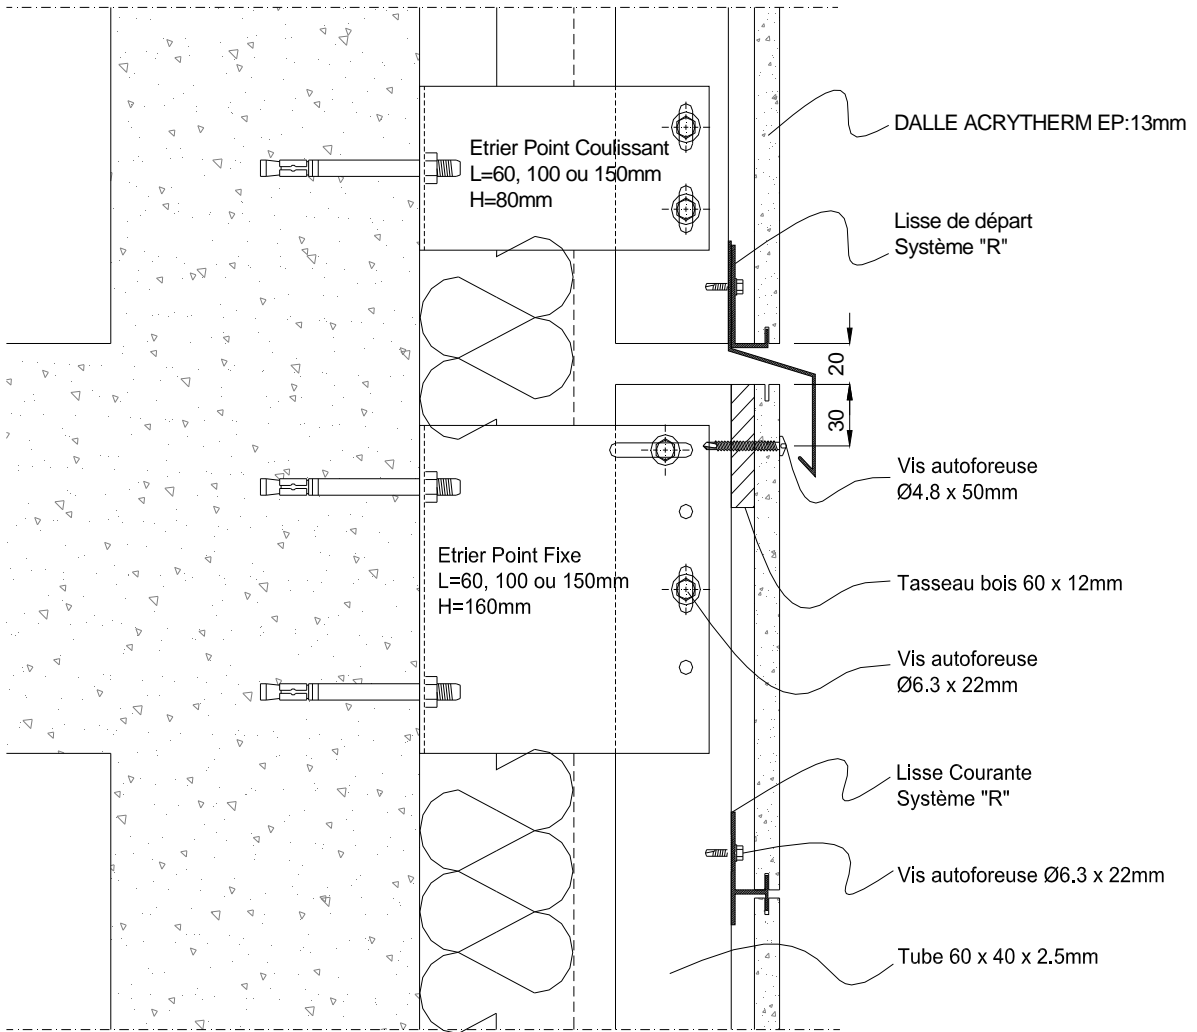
Coupe verticale sur joint de fractionnement au droit de chaque plancher
